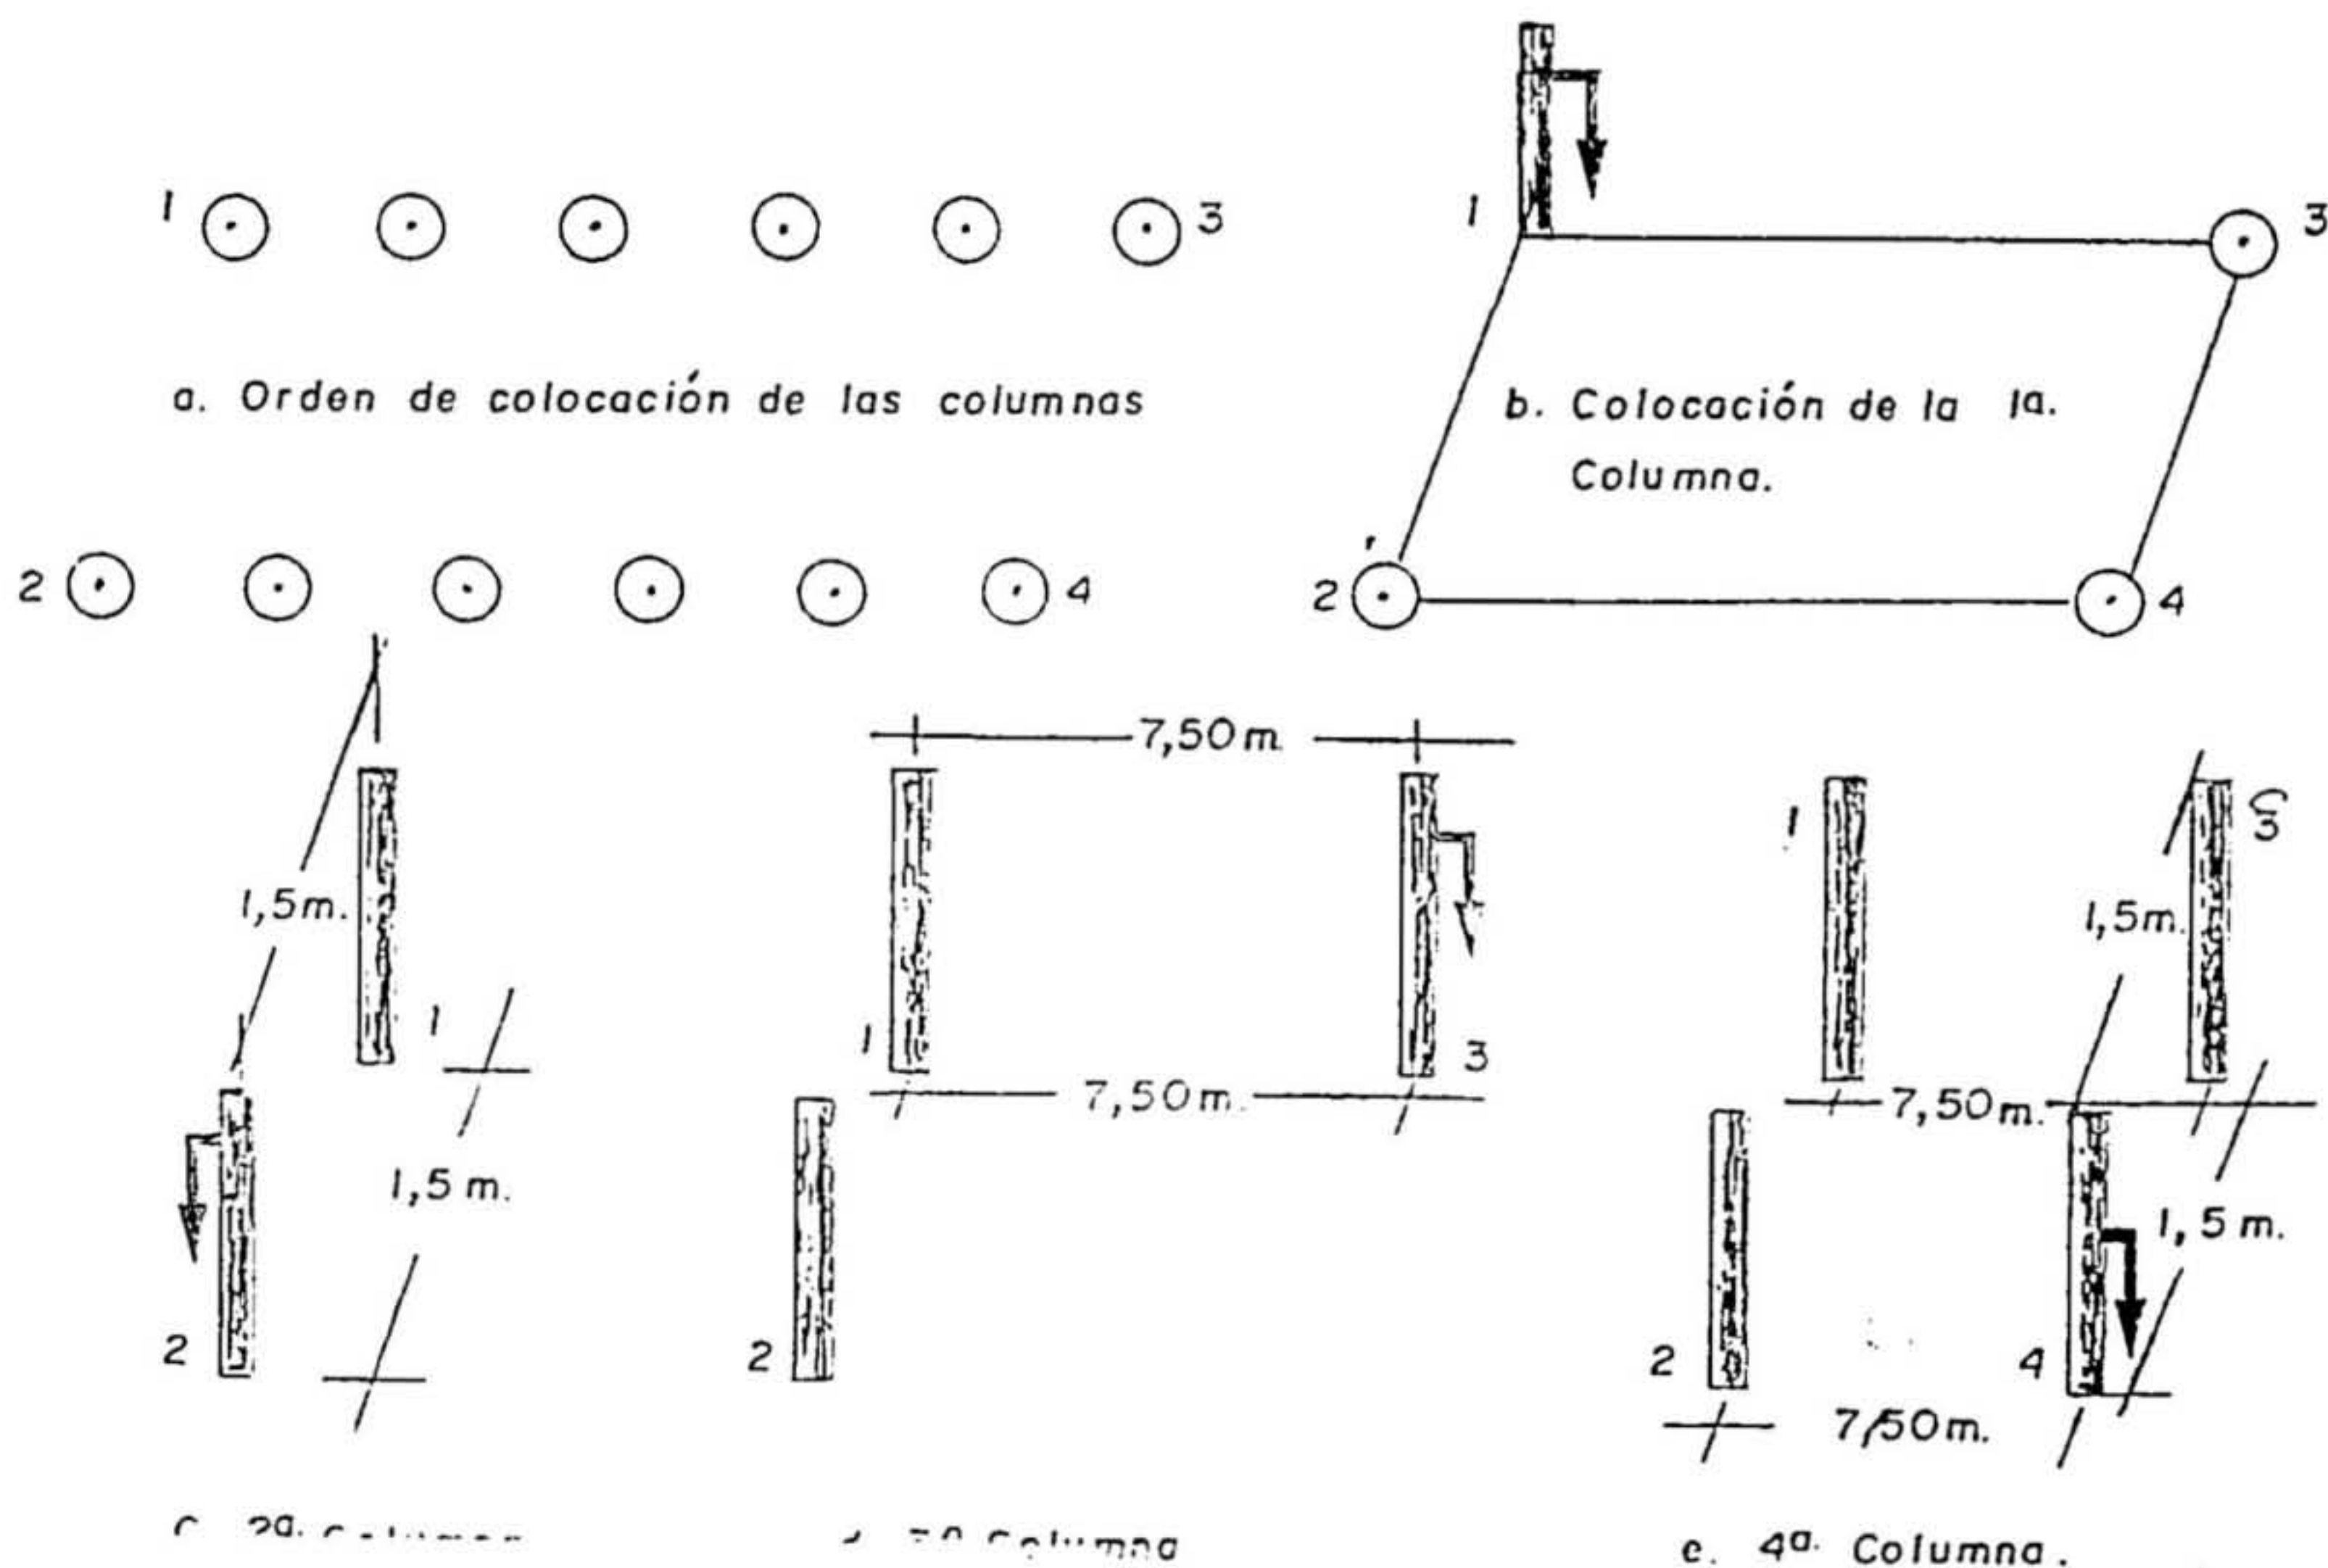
Colocación de las columnas. a) Planta; b) 1^a columna; c) 2^a columna; d) 3^a columna; e) 4^a columna.
